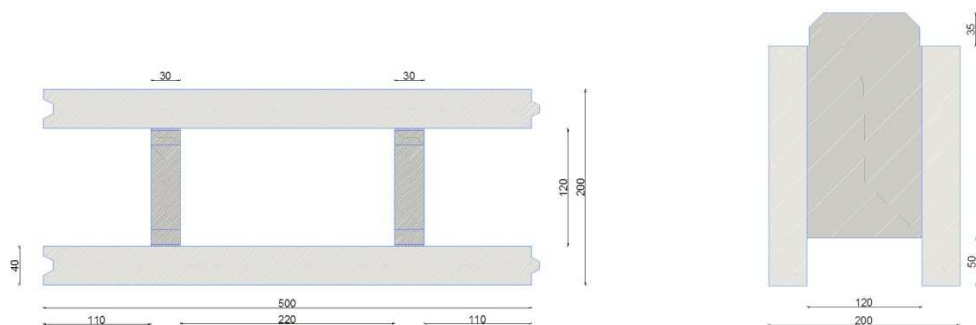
Coupes en plan (à g.) et transversale (à d.) du bloc de béton
